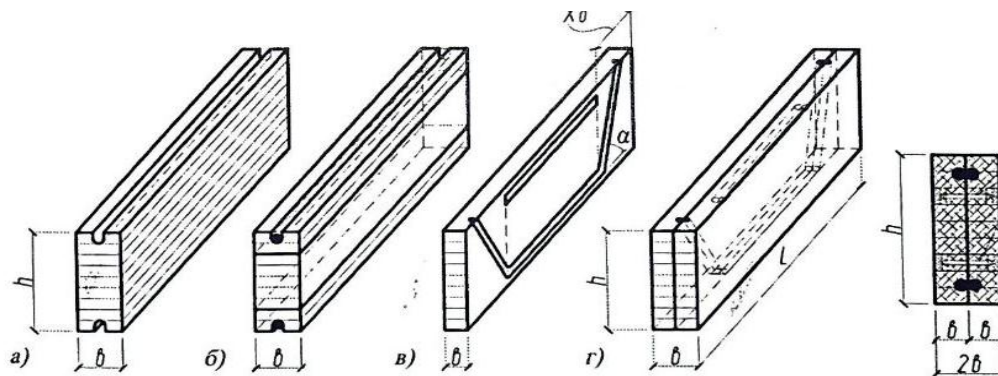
Наиболее распространенные виды клееных армированных балок.
